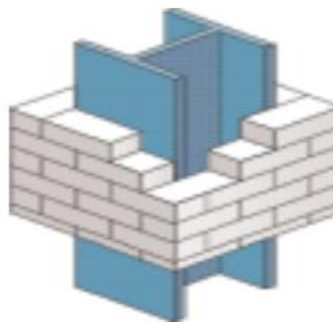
exemple d'un poteau intégré à la maçonnerie [9]
